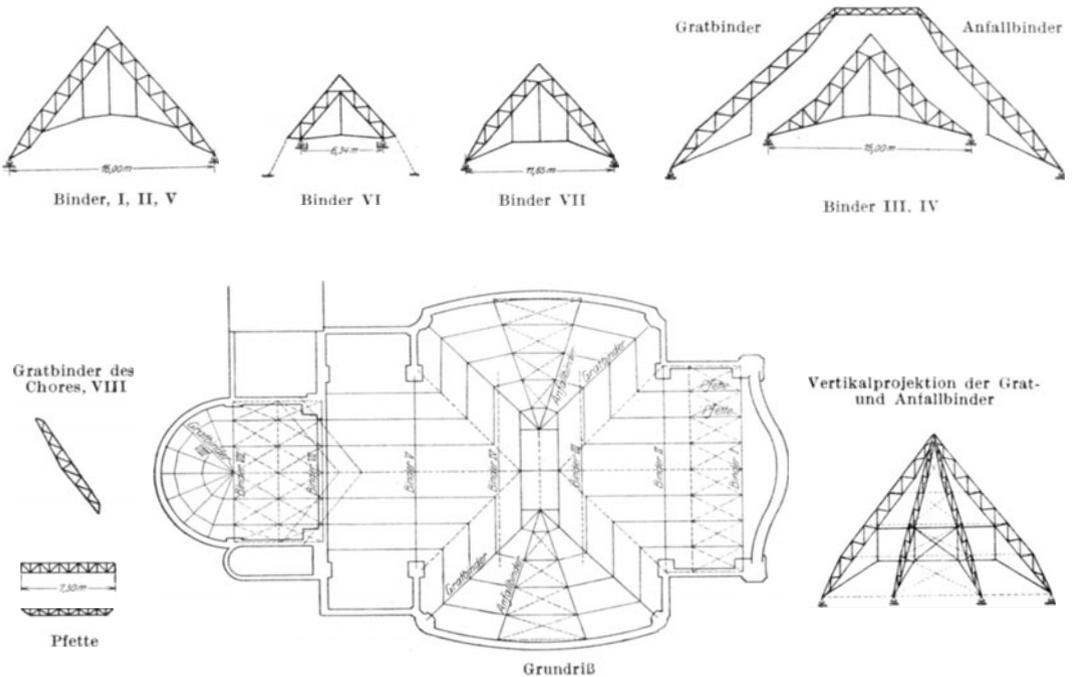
Dachbau einer Kirche in Ingolstadt. Gesamtanordnung der Binder.
